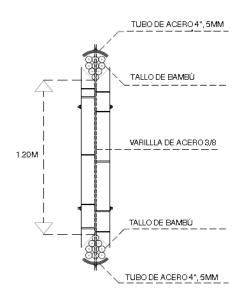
Detalle constructivo de tallos de bambú con varillas metálicas
